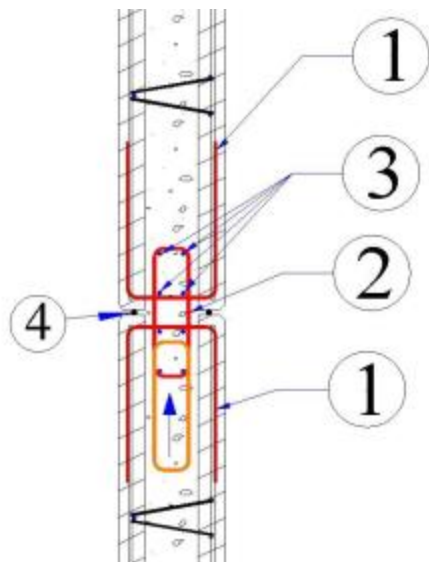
Liaisons horizontales articulées (murs de faible épaisseur) – mur continu - plancher intermédiaire
